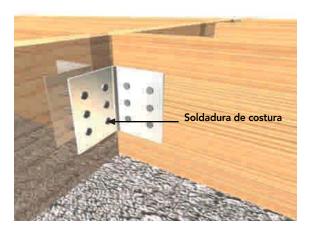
46: Conector fabricado con pletina de espesor 3 a 4 mm conformado por dos piezas que se unen mediante soldadura de costura, como se puede apreciar en la figura.
